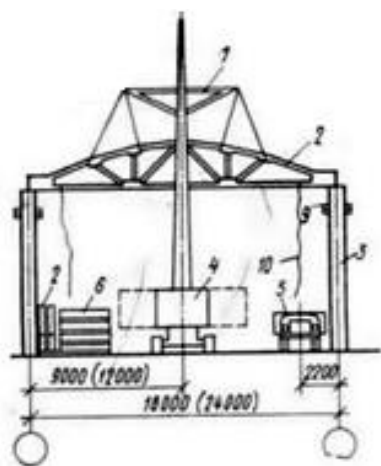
Схема монтажа фермы пролетом 9, 12, 18 и 24 м и плиты перекрытия проным методом: 1 – траверса; 2 – стропильная ферма; 3 – колонна; 4 – кран; 5 – транспортное средство; 6 – штабель плит; 7 – монтируемая плита; 8 – временное ограждение; 9 – ница-площадка приставная; 10 –оттяжка.
